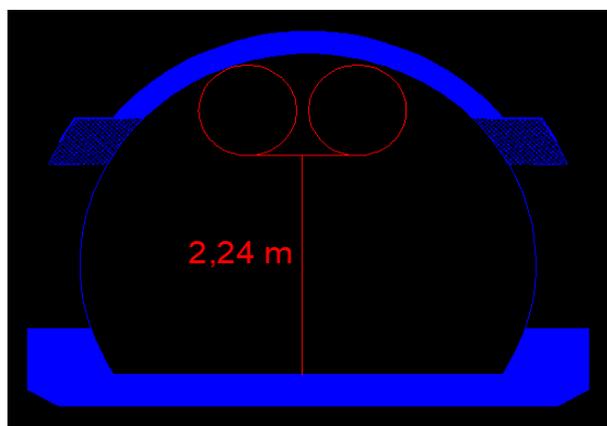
Installazione di n.2 condotti di aerazione affiancati, con funzionamento in parallelo e aventi sezione 400 mm
